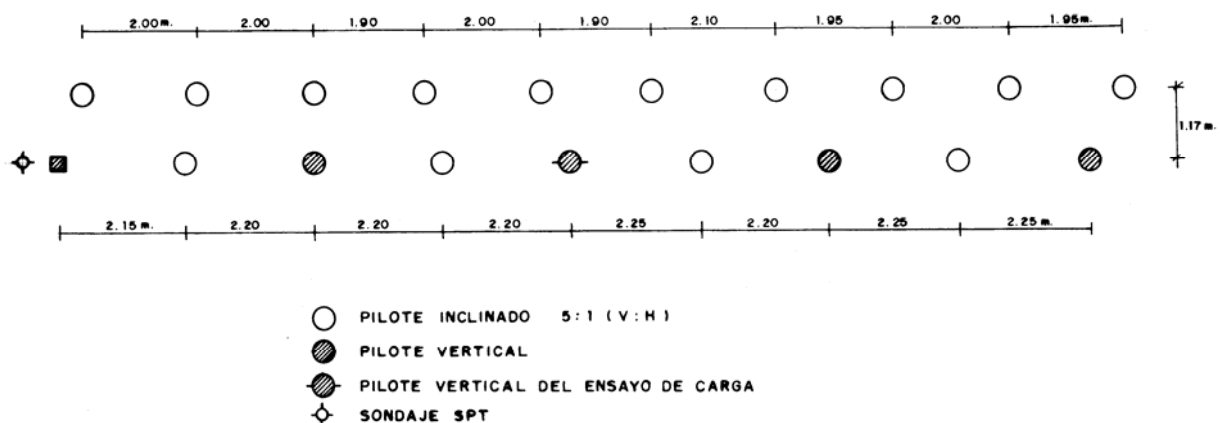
UBICACION "IN SITU" DE LOS PILOTES TIPO FRANKI (Estribo Este Puente Killman, Cochabamba Bolivia)
